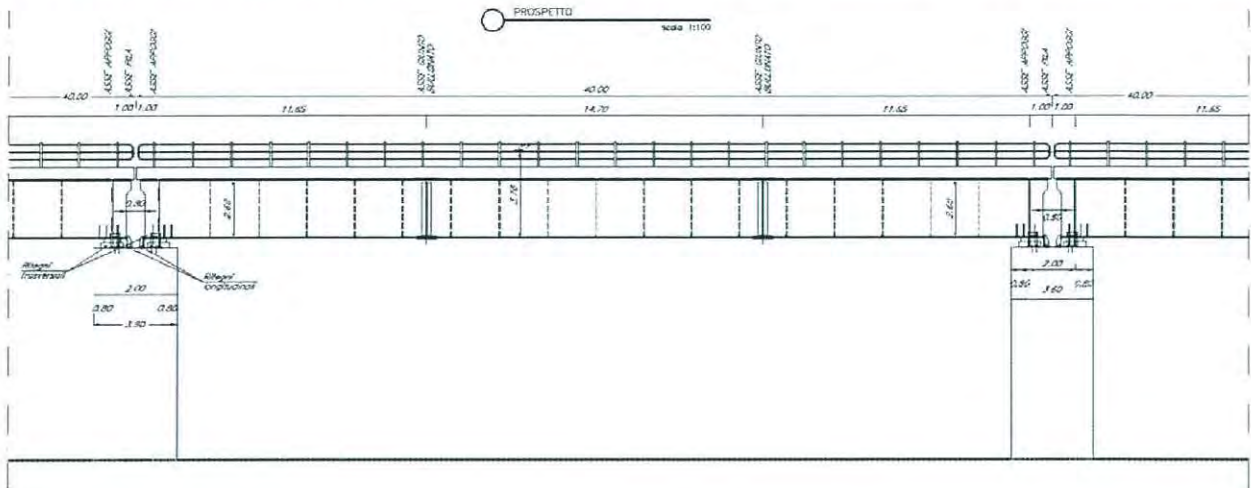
Prospetto impalcato a struttura mista acciaio/cls.
